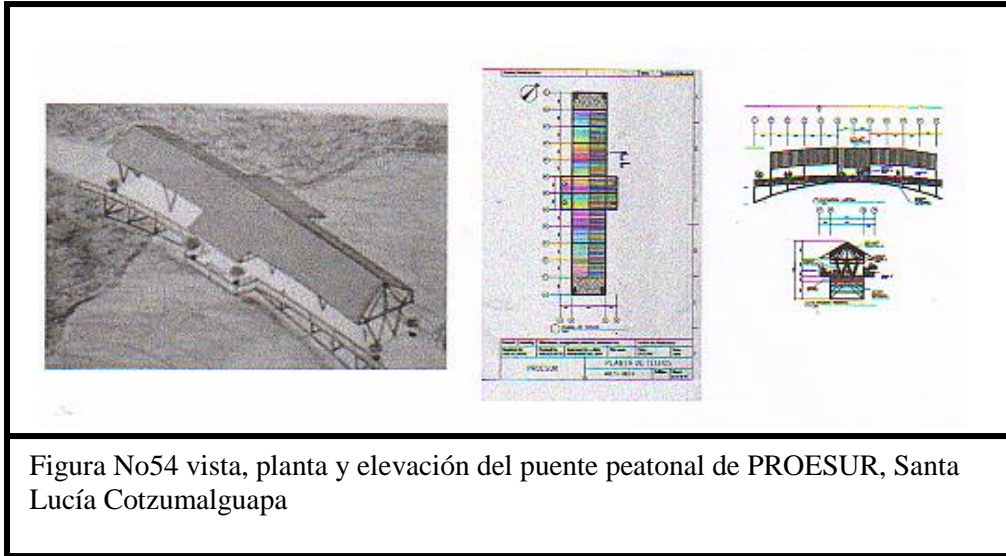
vista, planta y elevación del puente peatonal de PROESUR, Santa Lucía Cotzumalguapa
